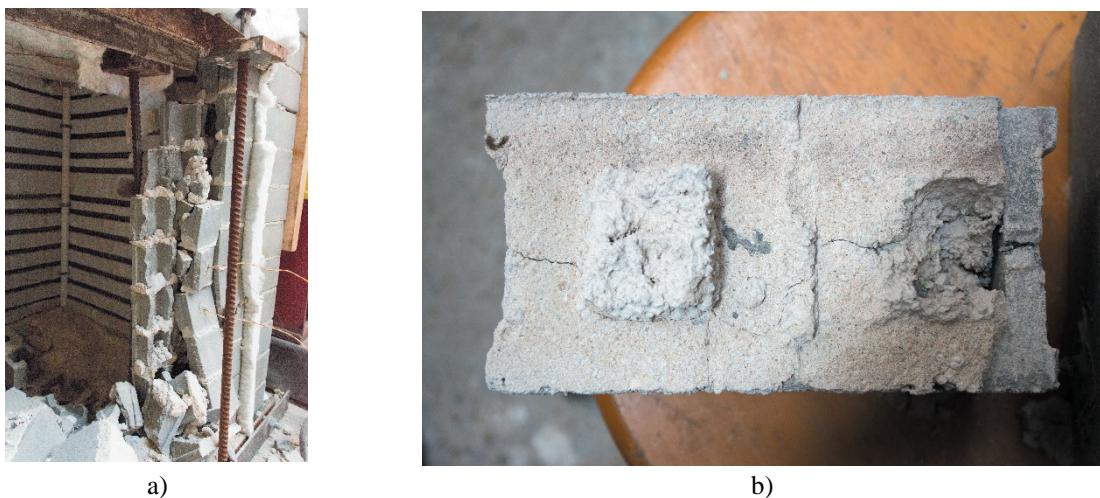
Provete 4 – a) Fissuração vertical em ambas as direções do plano da parede; b) Bloco com fissuração
